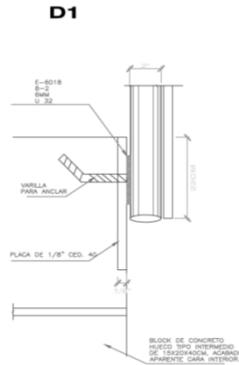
Detalle de fijación de postes en cadena de cerramiento
